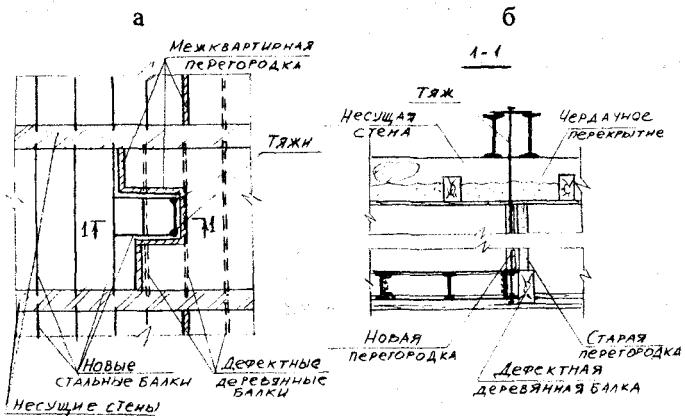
Усиление фрагмента перекрытия на стыке двух квартир: а – план; слева – реконструируемая квартира; б – разрез 1-1; конструкция подвески элементов усиления
